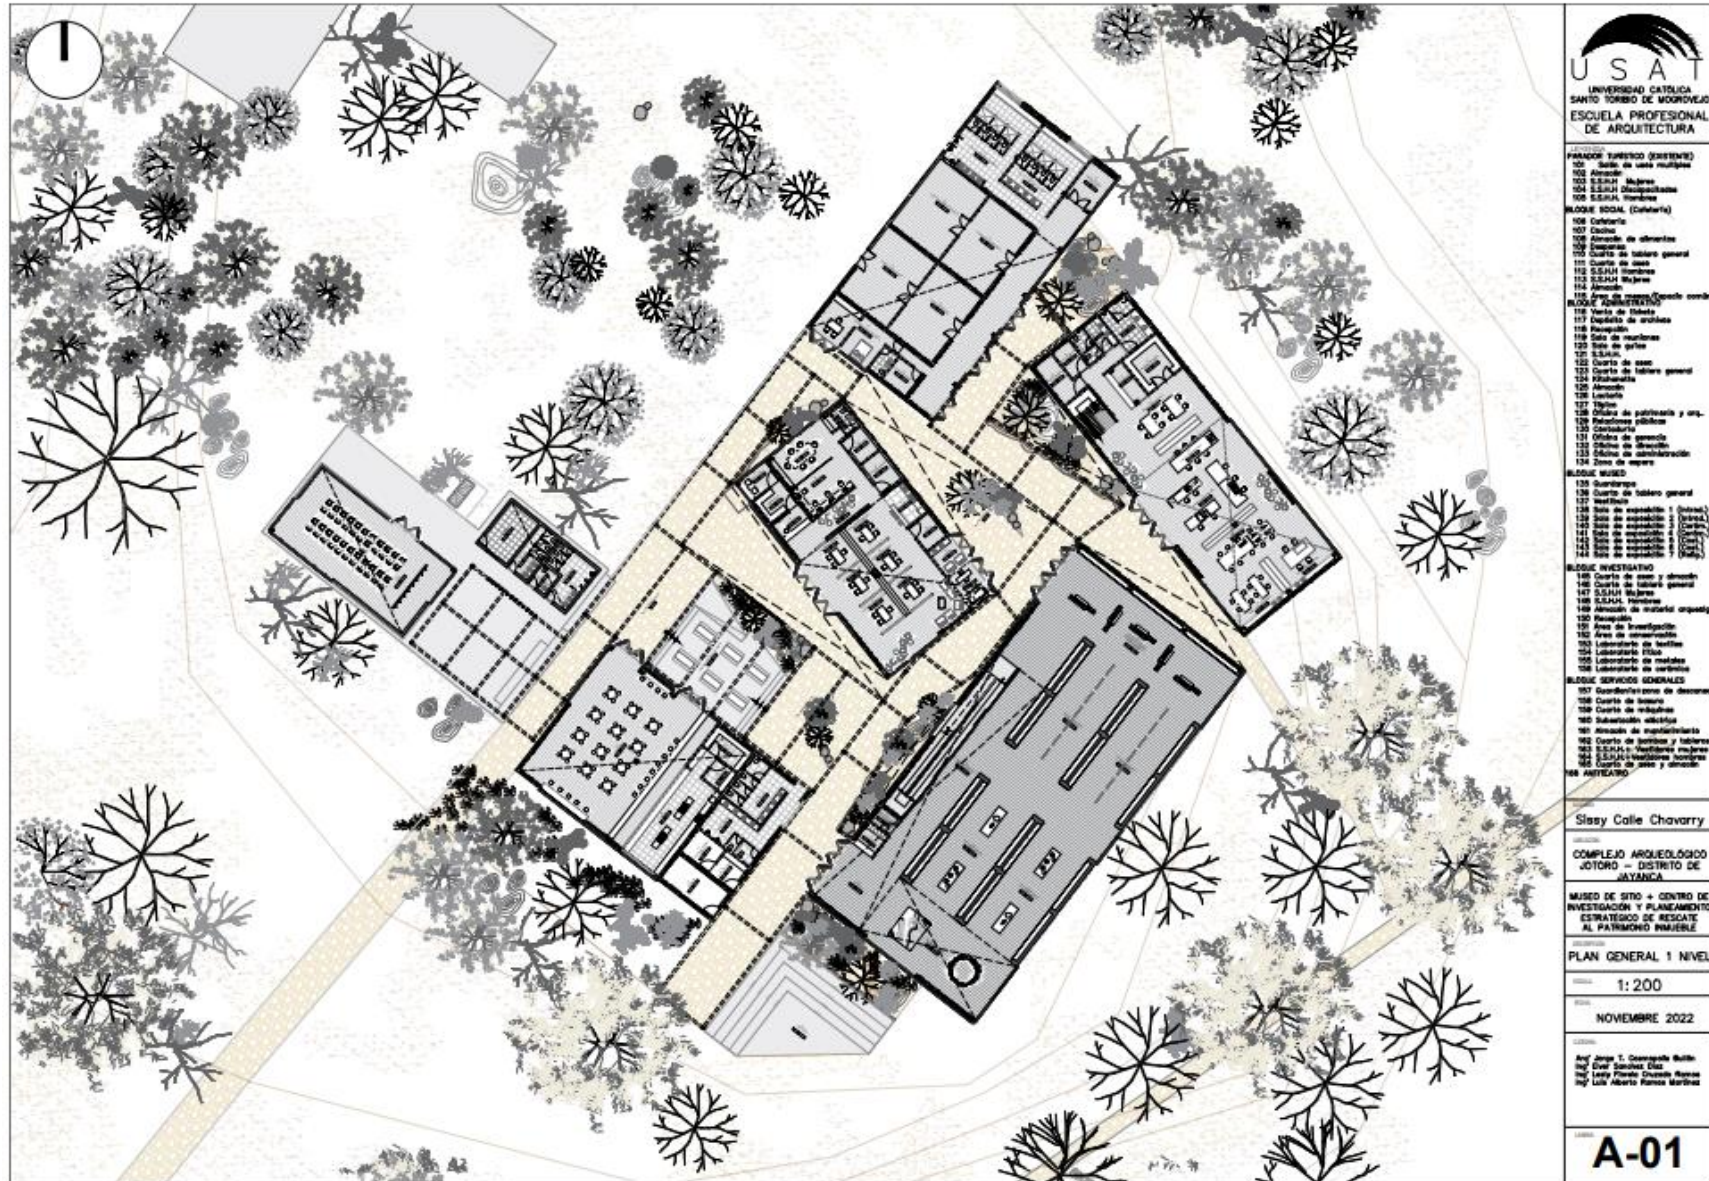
Planta arquitectónica 1er Nivel. Fuente: Propia
